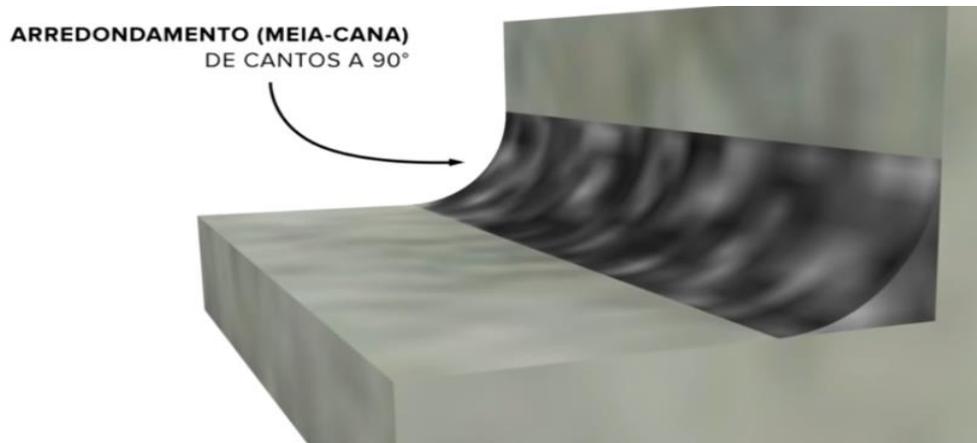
Arredondamento dos cantos vivos e arestas para impermeabilização (CONSTRUIRSOZINHO, 2023).
